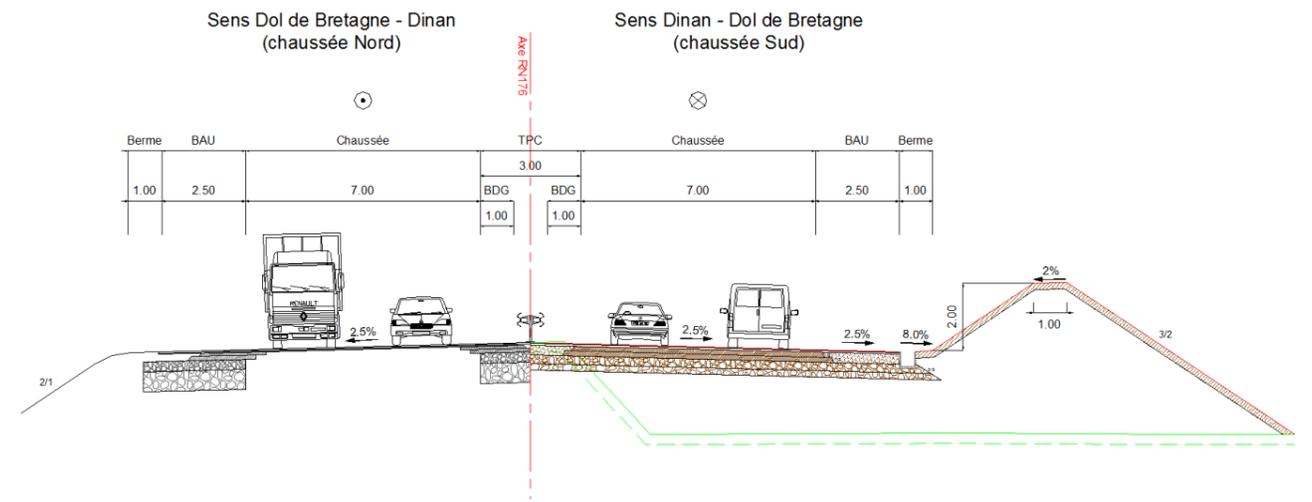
Profil en travers de la section courante en remblai avec merlon (source ARCADIS)
